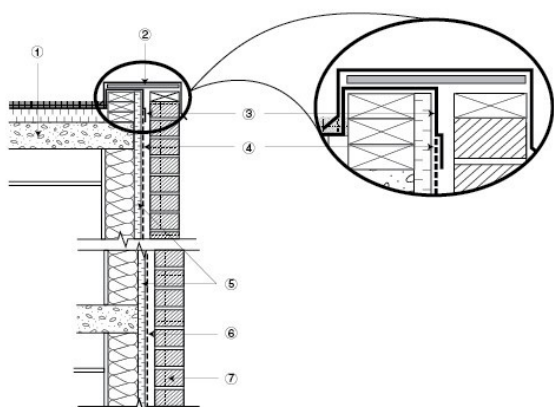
Tyvek® CommercialWrap® – Coupe transversale de mur extérieur, continuité entre le sommet du mur et le plafond
